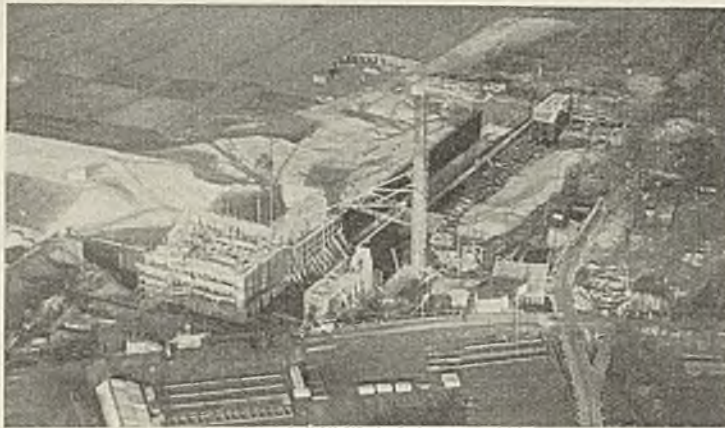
Luftaufnahme der letzten Betonarbeiten.
